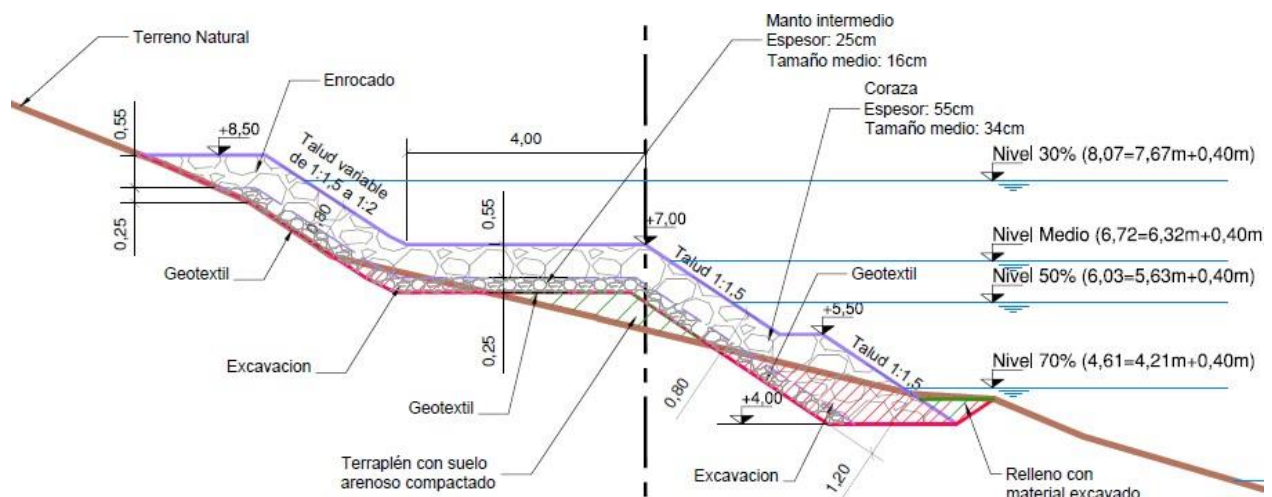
Perfil Tipo 4. Perfil tipo de defensa entre progresivas 400 m a 1590,95 m.
